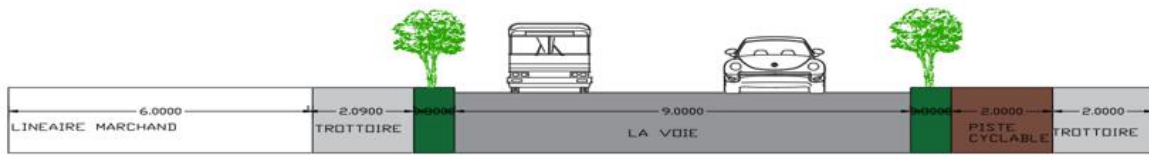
35 : coupe d'intervention sur la rue Boulila Amar
